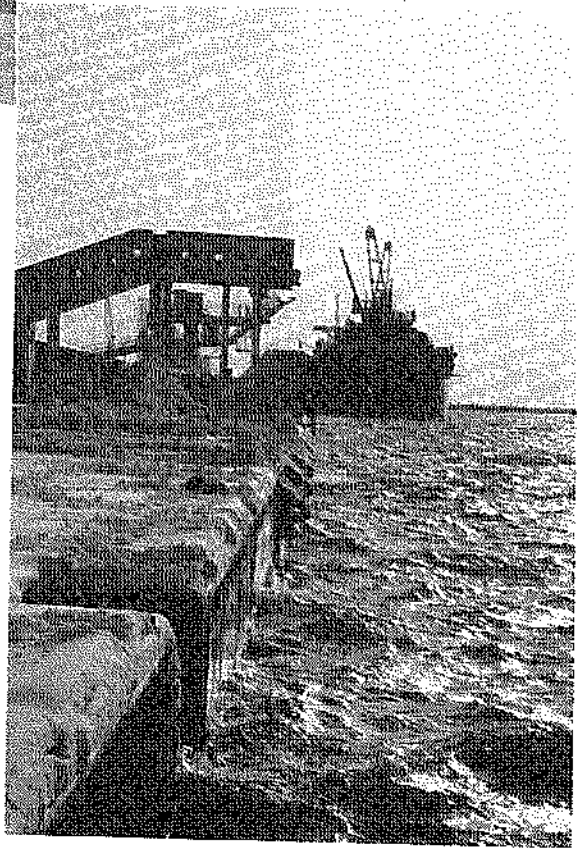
法線変位状況 (第1埠頭地区, ㊸西側岸壁
